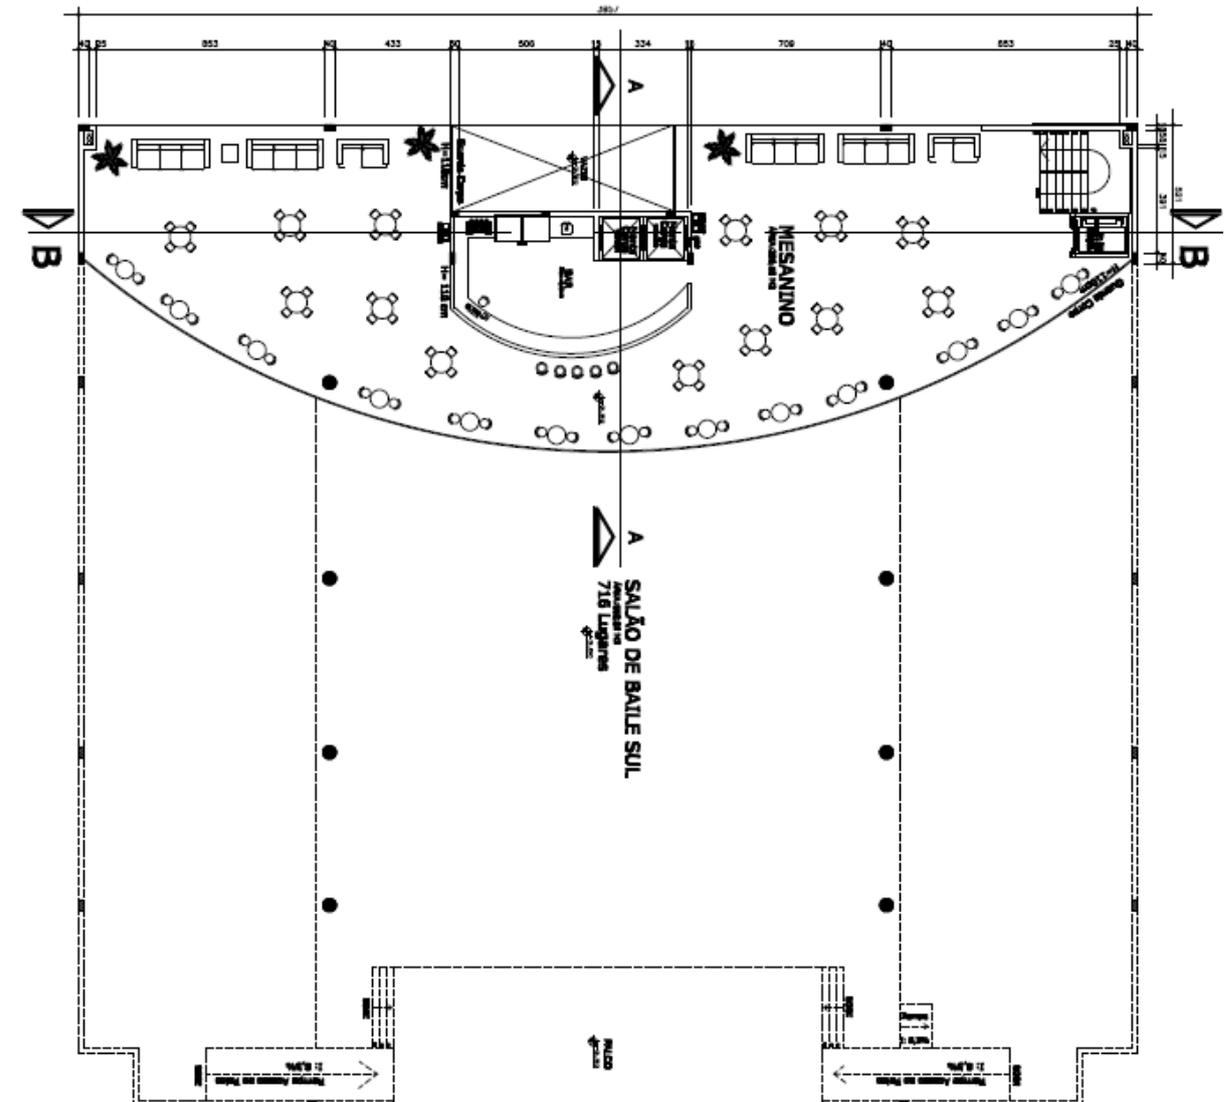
Planta Baixa / Pavimento Superior – sem escala
